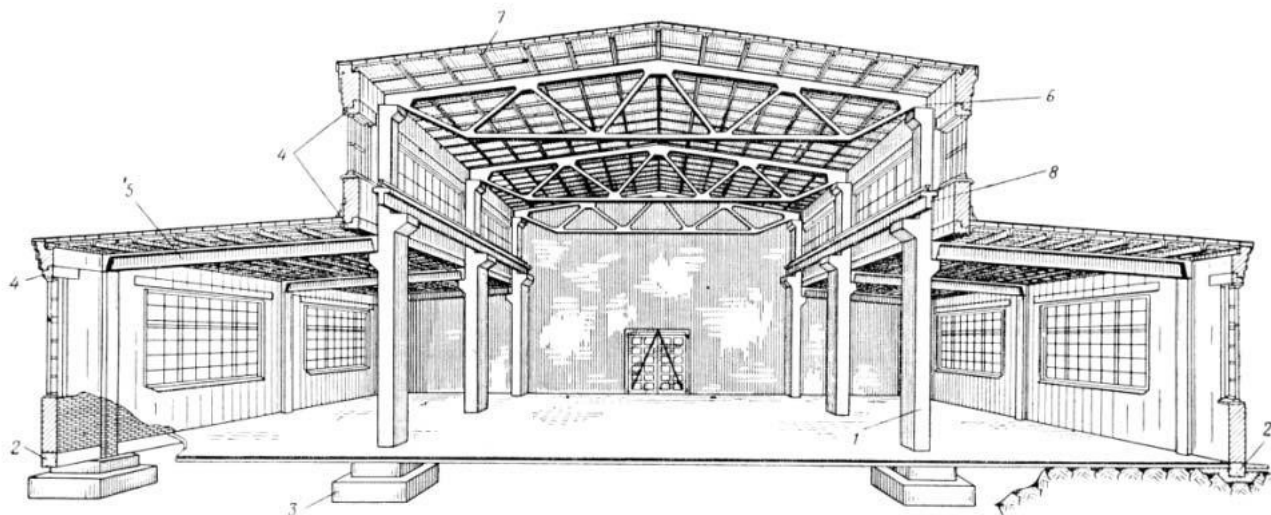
Одноэтажное каркасное промышленное здание с железобетонным каркасом:
